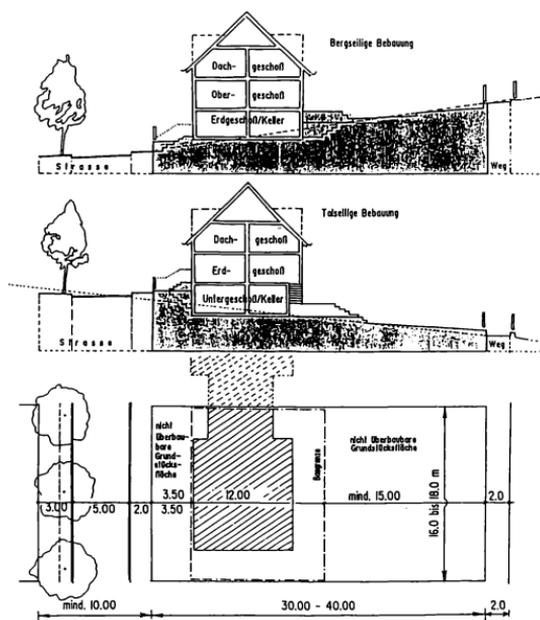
Ausschnitt aus dem Plan 'Siedlungserweiterung'
